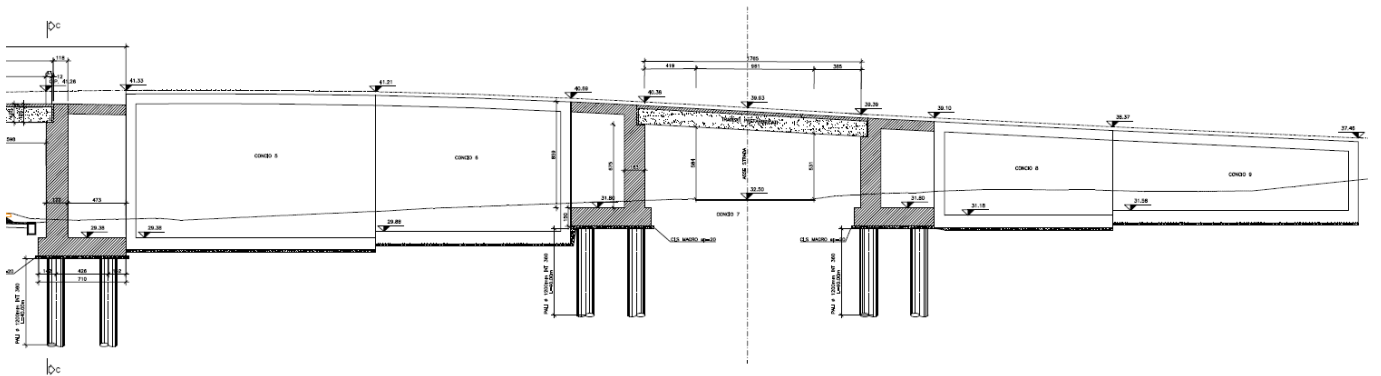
Sezione longitudinale 2 (da concio 5 a 9)
